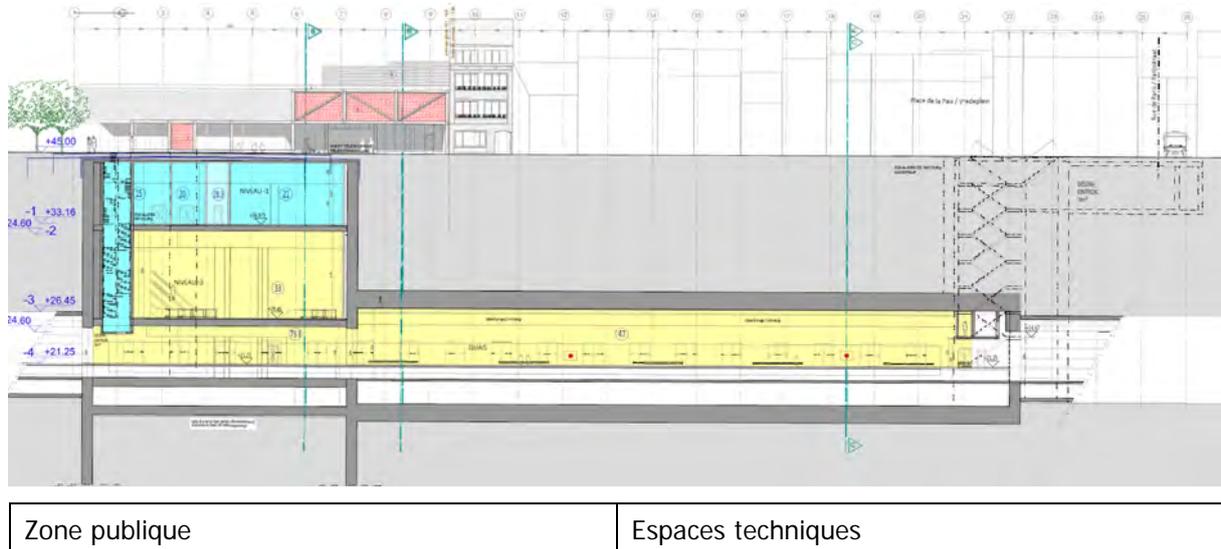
Station Paix, coupe longitudinale (BMN, 2018)
